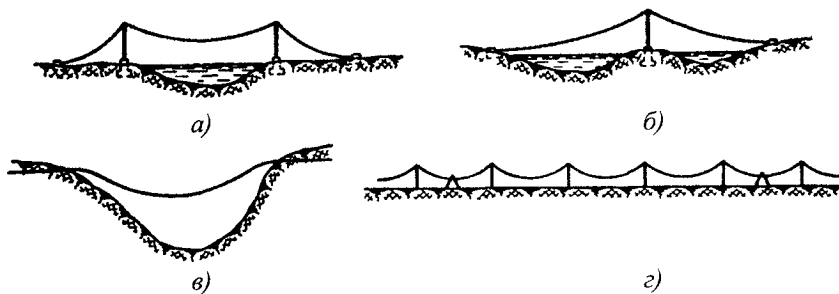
Схеми переходів у вигляді нитки, що провисає: а, б, з – з передачею розпору на анкерні опори; в – з передачею розпору на підземну частину трубопроводу
